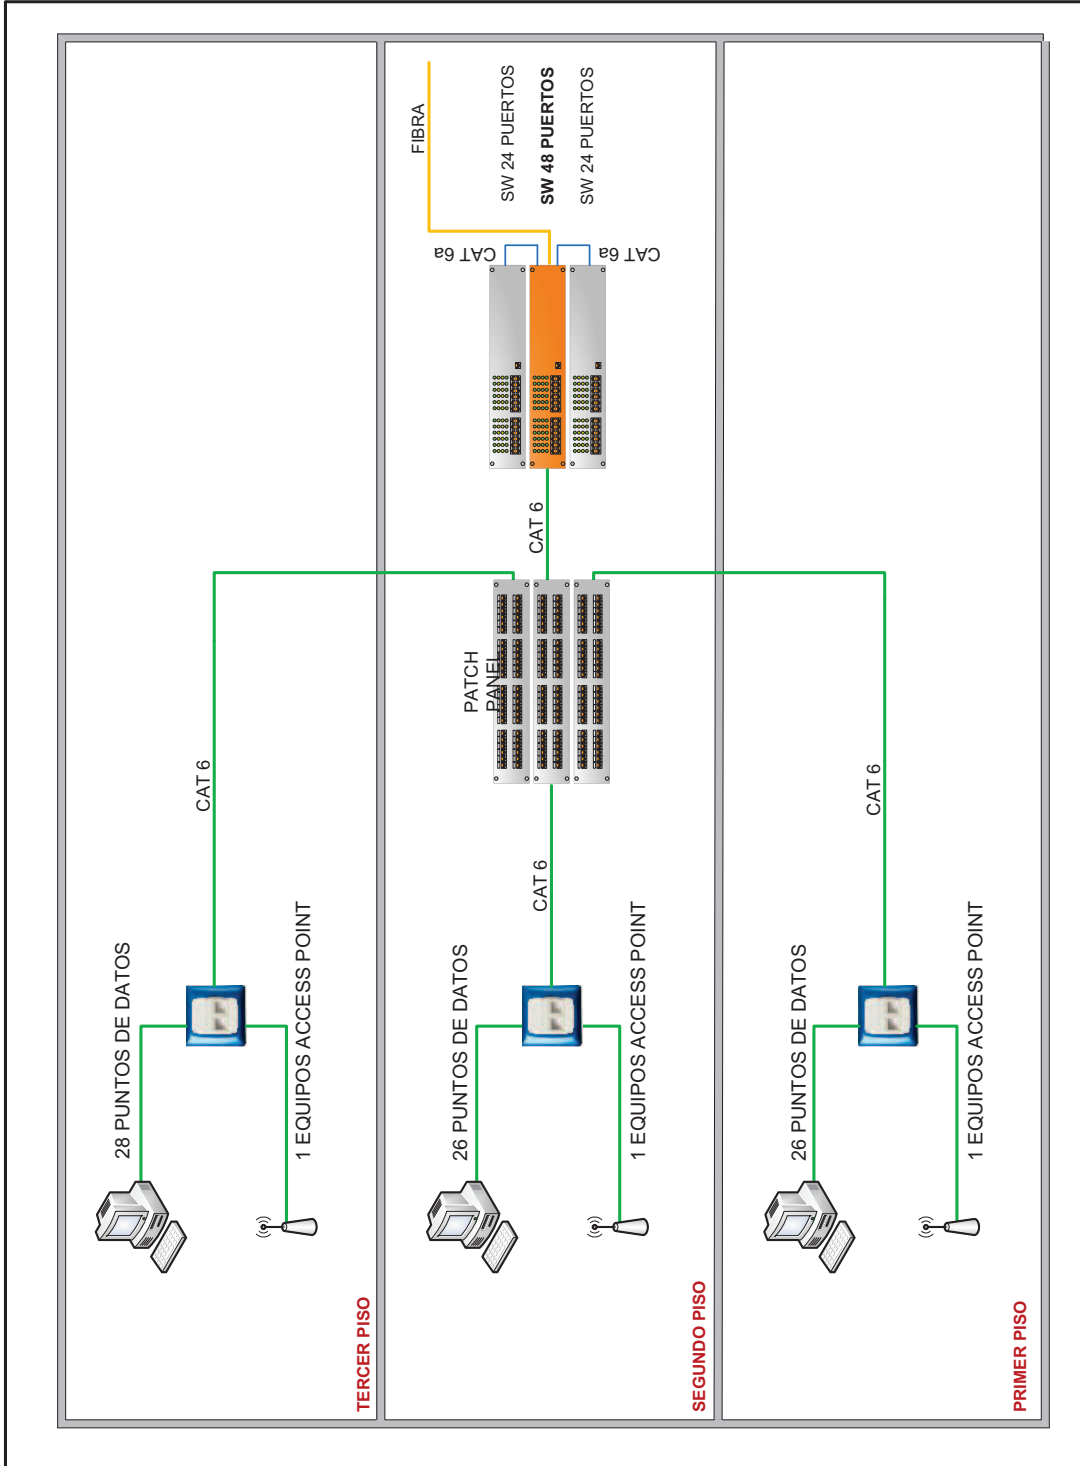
Cableado horizontal y vertical en el edificio Sur - Talleres
